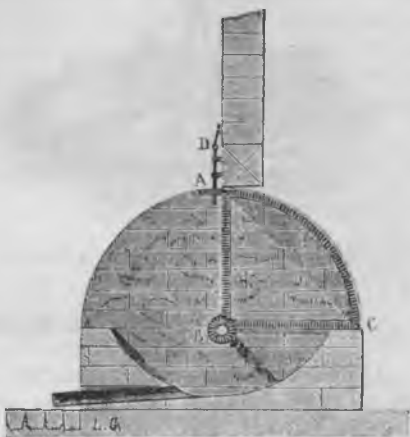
Разрѣзъ корыта съ цилиндрической крышкой.
